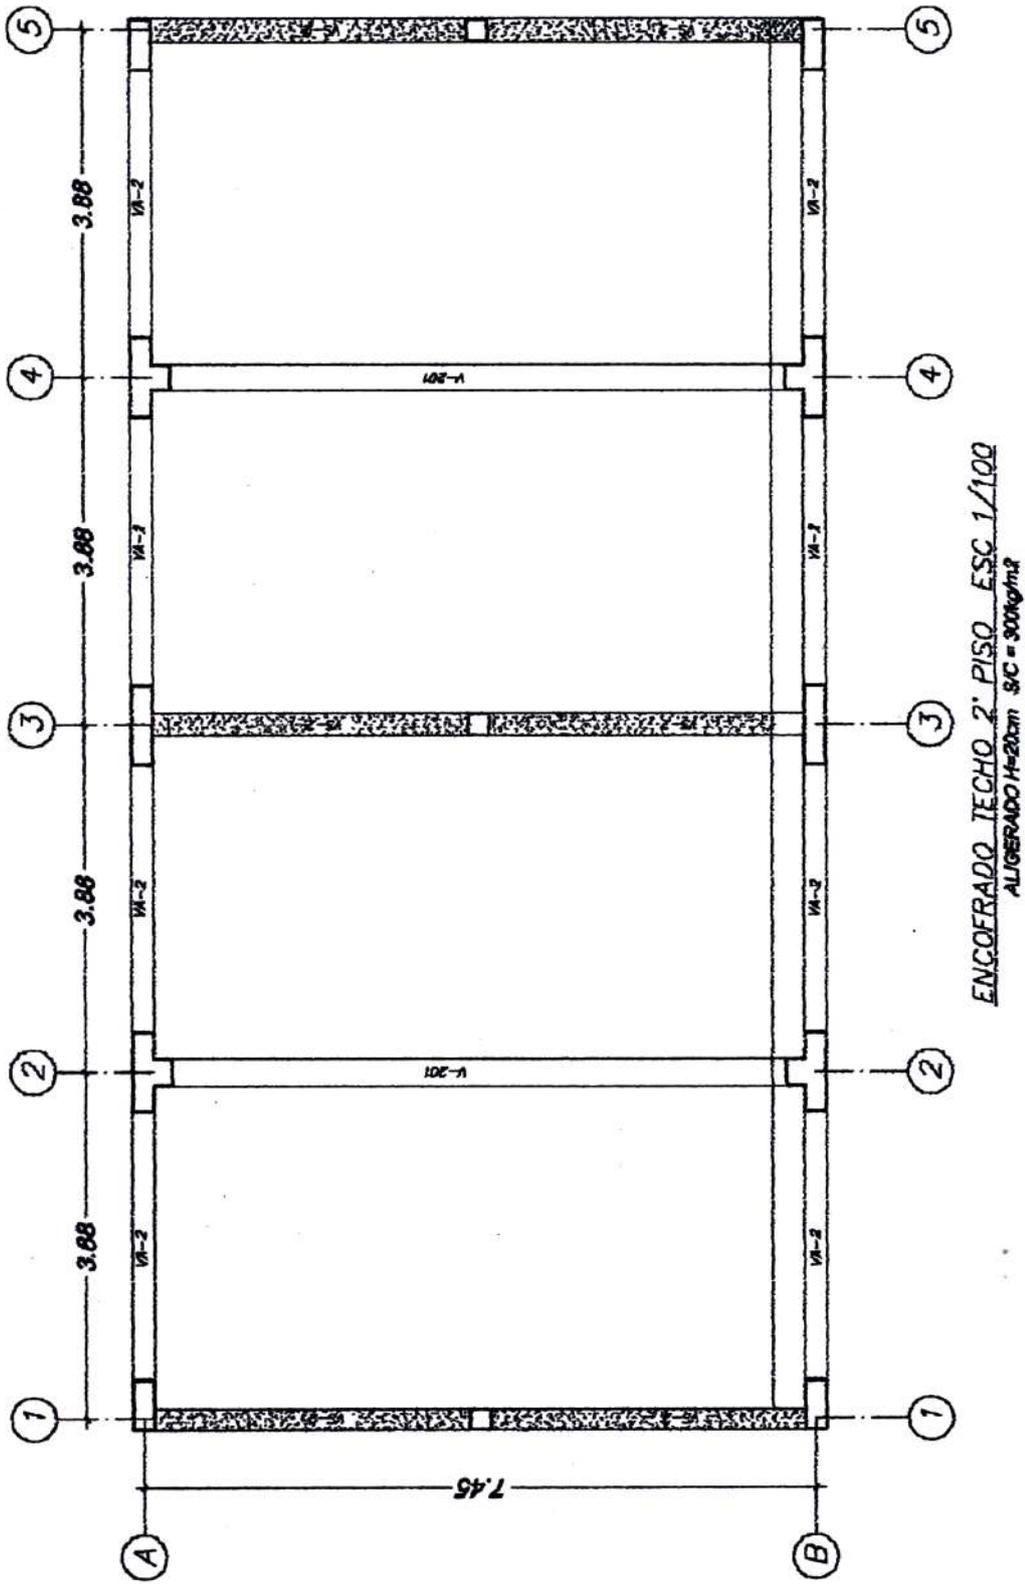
PLANTA ENCOFRADO DE TECHO 2° PISO – MODULO 2 AULAS-2 PISOS (ESC 1/100)
